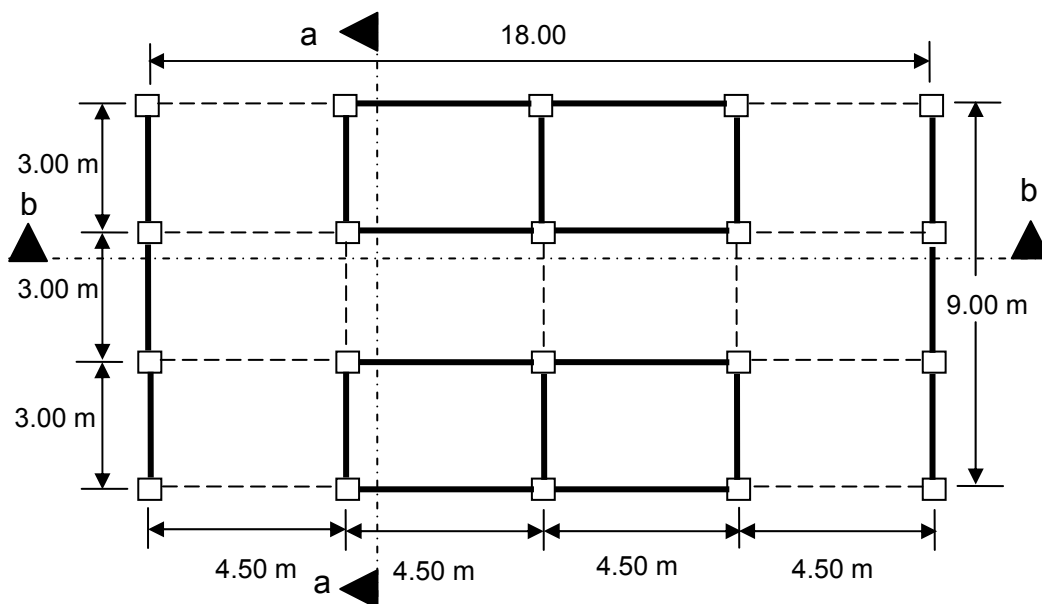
Planta estructural del edificio de 7 niveles para oficina.
